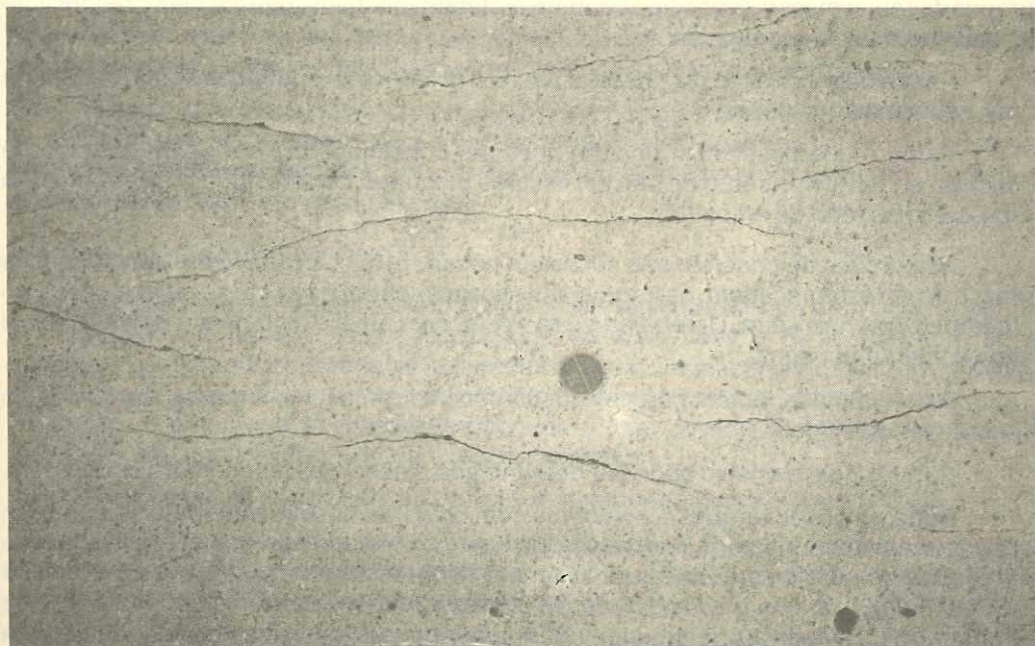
Fissuração devida à retração por secagem
